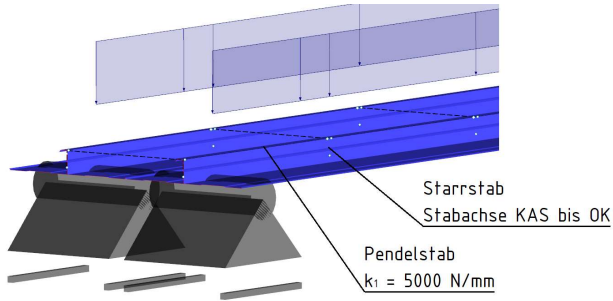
Detailansicht Stabwerksmodell mit Sandwichelement-Außenschale
